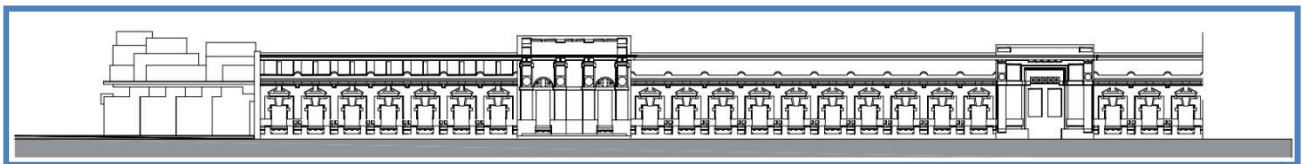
fabbricato stufe – PROSPETTO NORD-OVEST
